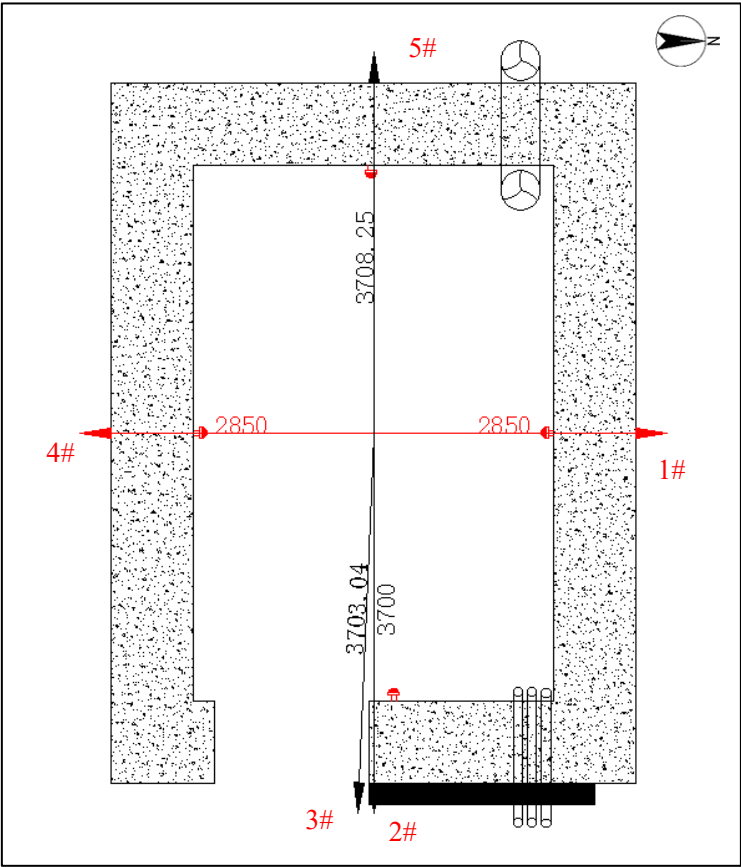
本项目测试间预测点位平面示意图（单位：mm）
